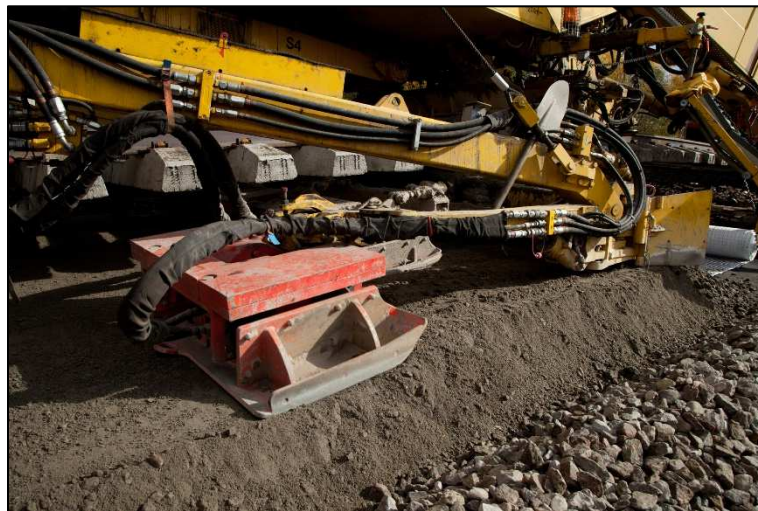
Plattenverdichter der AHM 800-R; Foto von Plasser & Theurer
